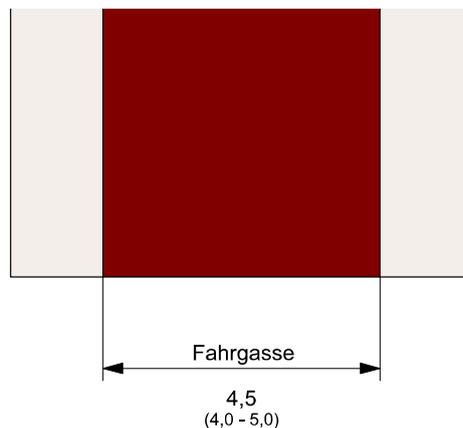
Fahrradstraße Typ I mit Fahrgasse ohne Parken
